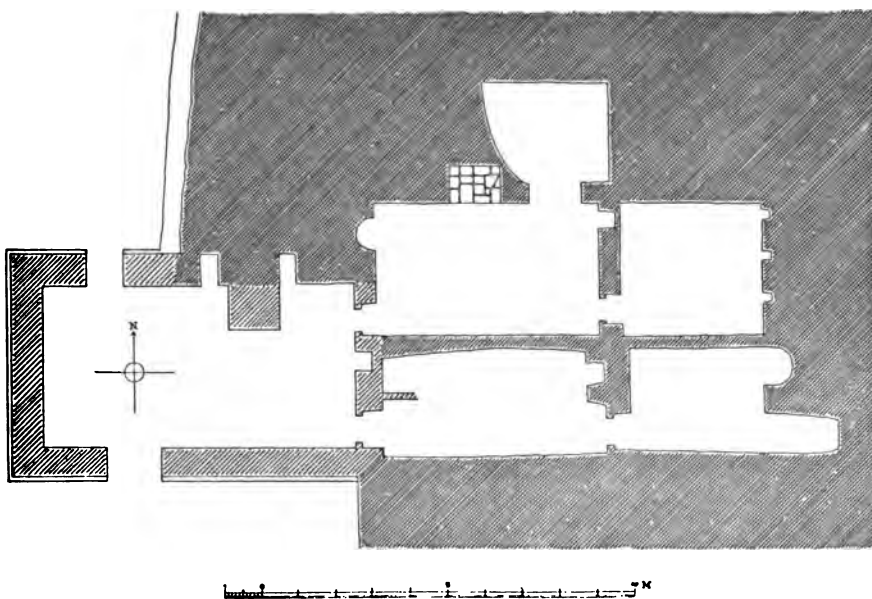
Hîrbet 'Abdo. Gräber mit einfacher Tür. Grundriß.
